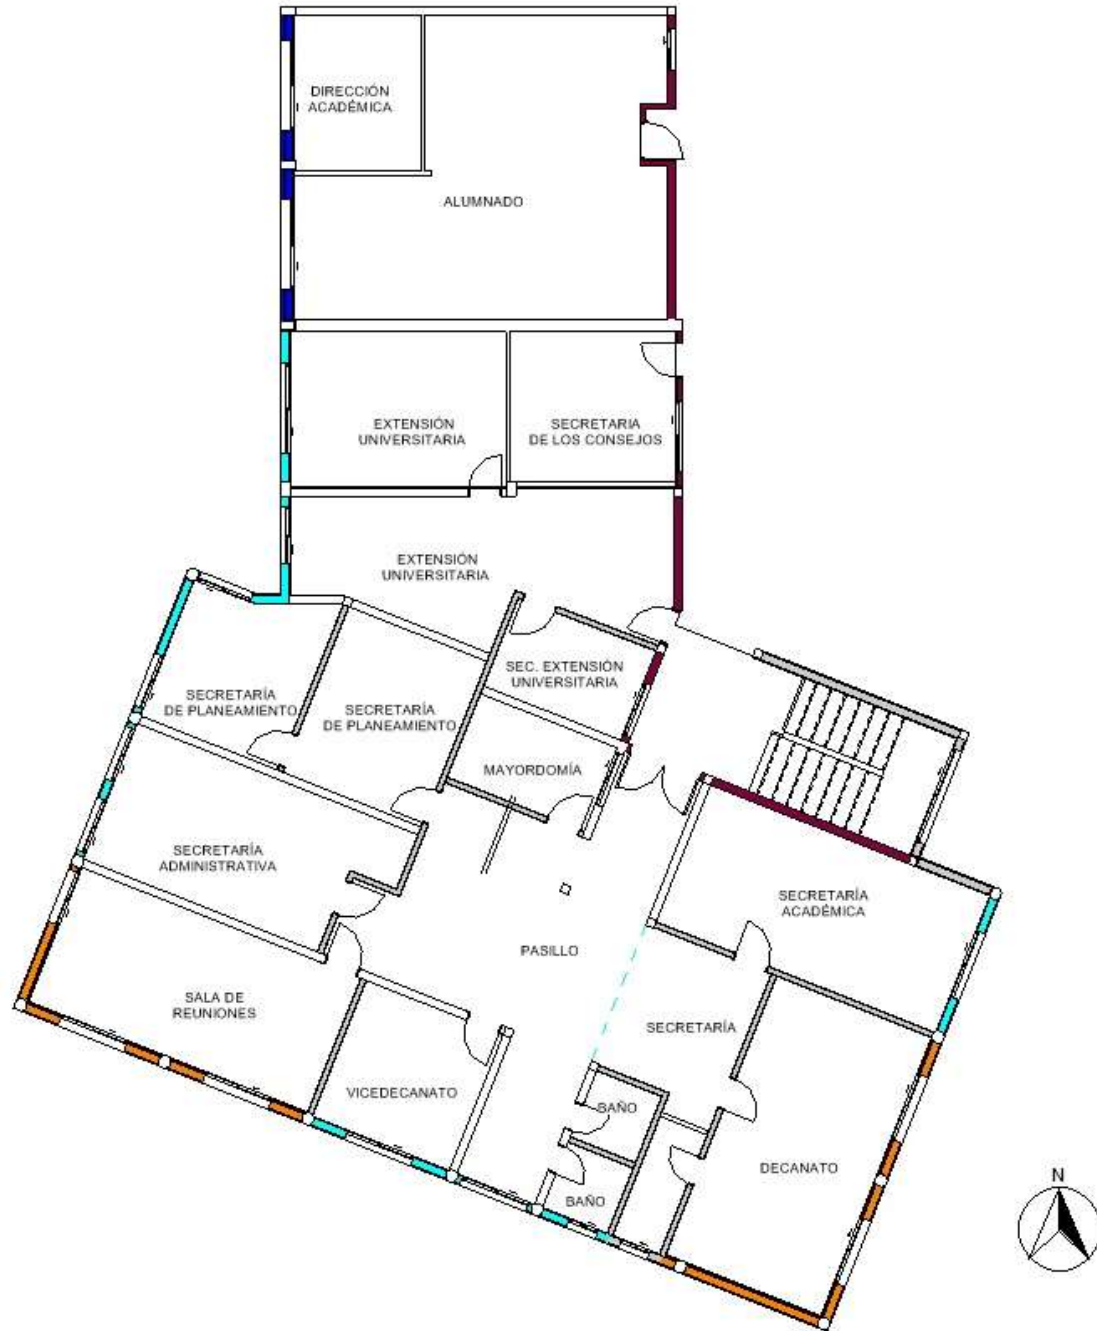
PLANTA ALTA – Esquema de ubicación tipo de muro
